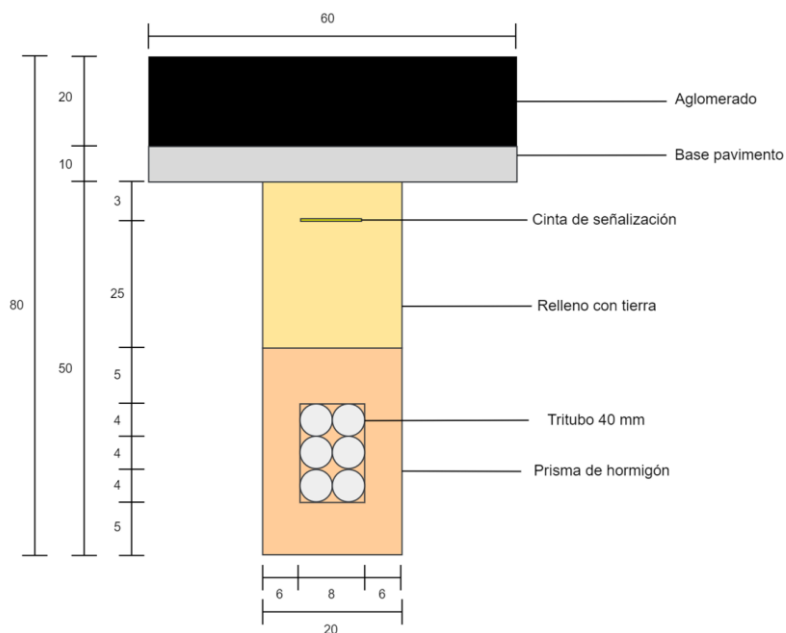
Minizanja con dos tritubos (6c40 mm) por calzada
